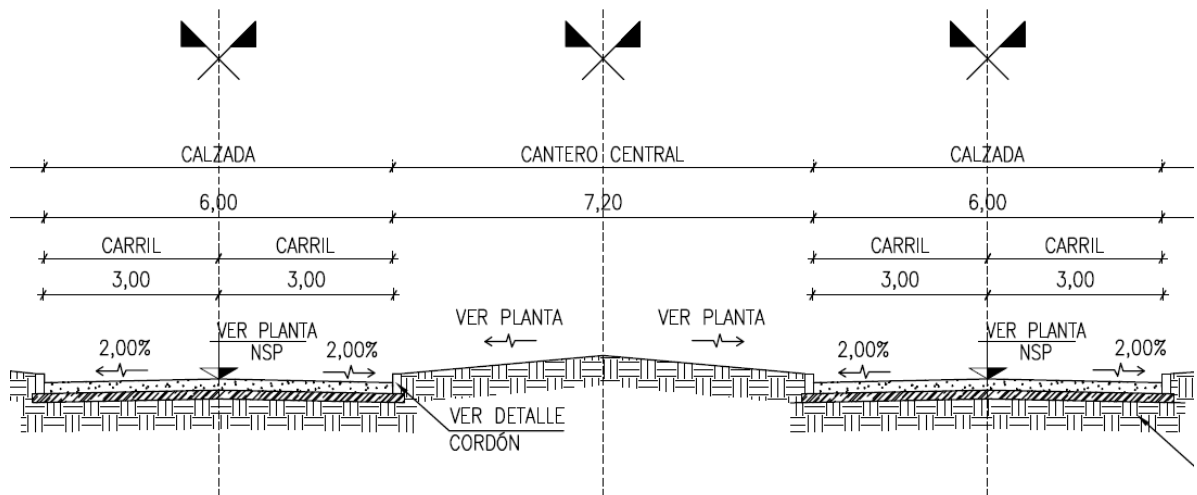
Perfil transversal tipo – Bv. Spangerberg
